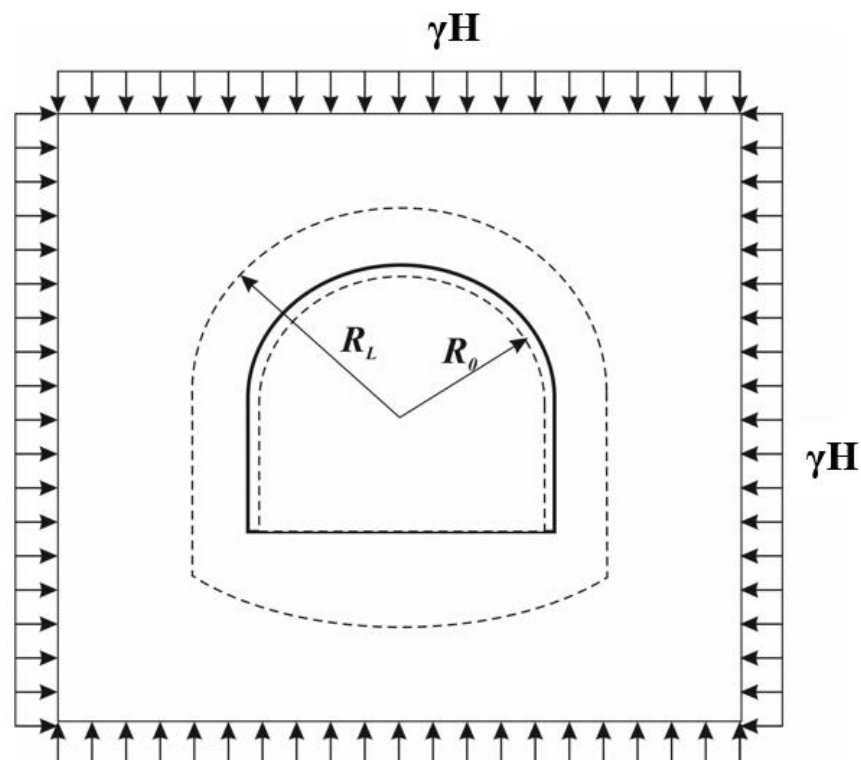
Розрахункова схема до вирішення пружно-пластичної задачі геомеханічного стану виробки з зміцненими вмещаючими породами
